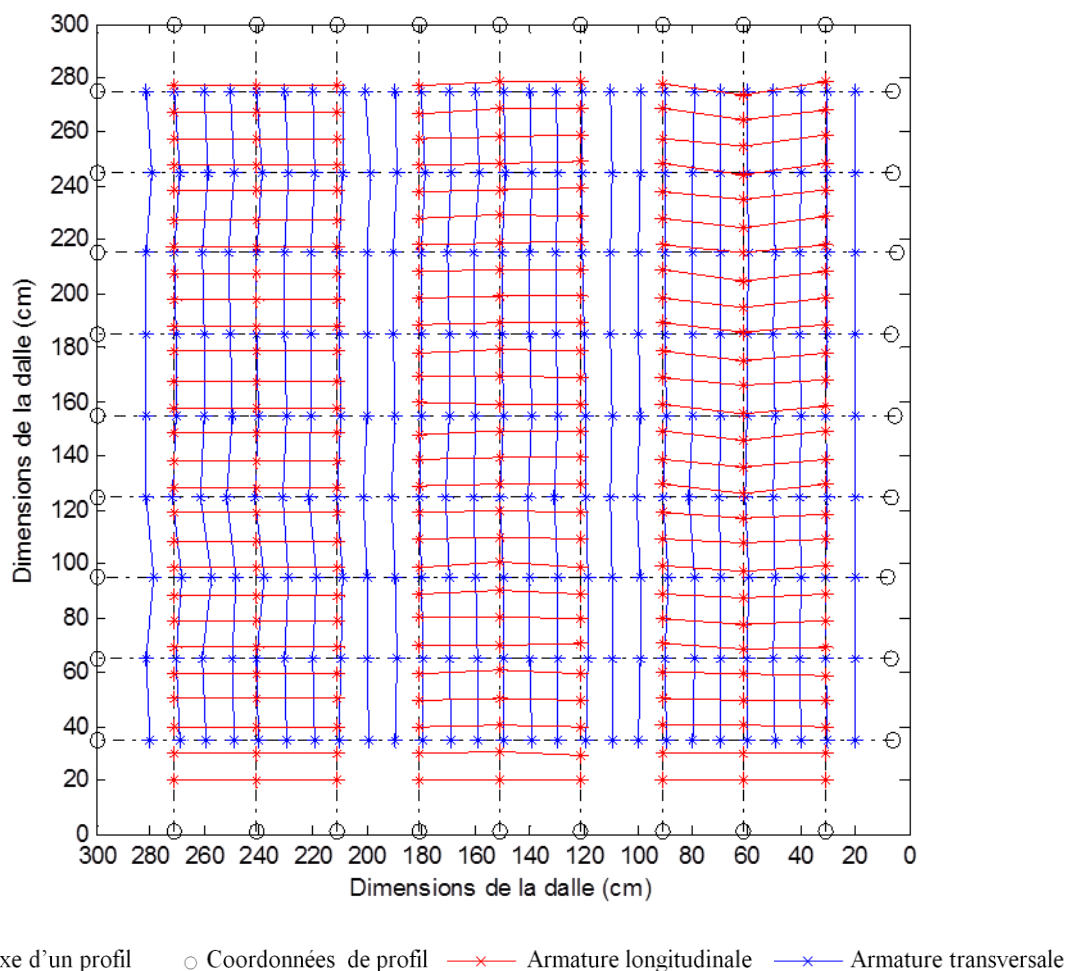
Cartographie des aciers du premier lit d'armatures de la dalle D1
